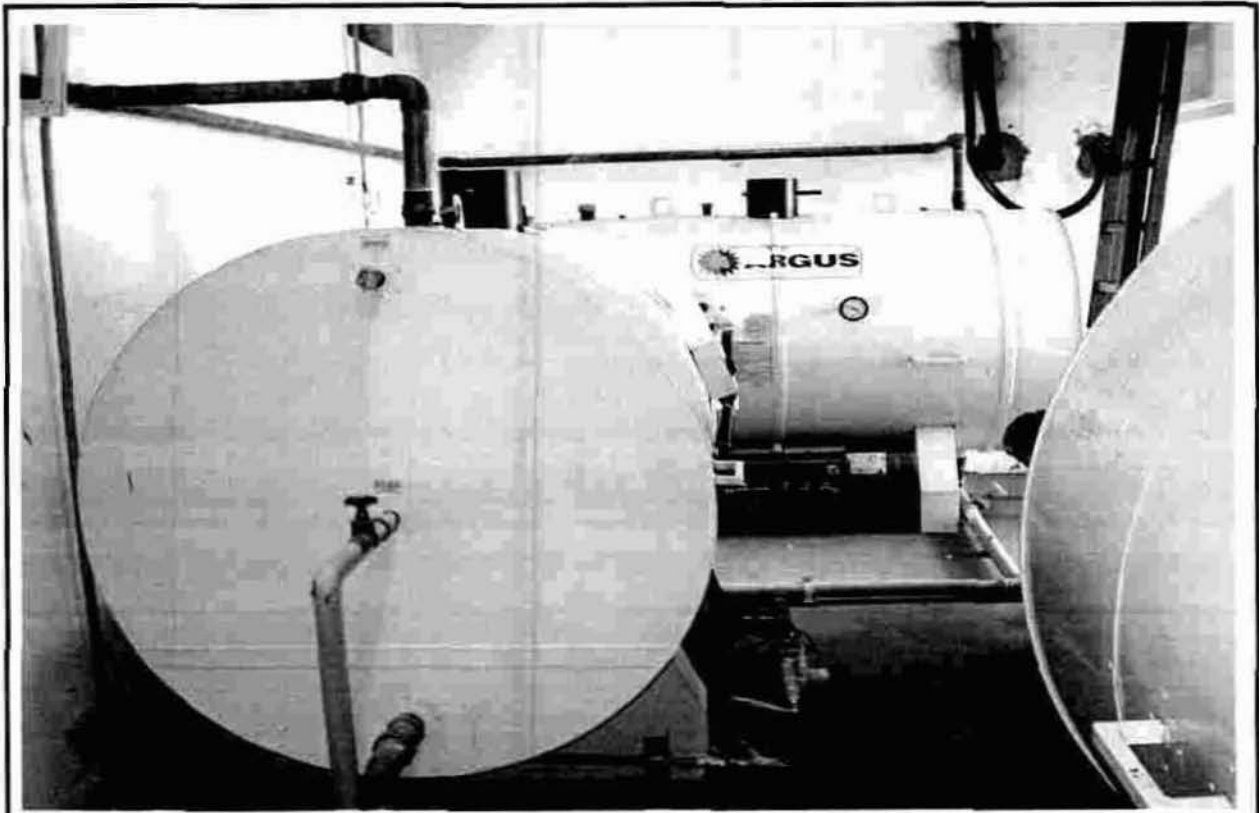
Sistema de Aquecimento/Hospital Regional de Ponta Grossa – Vista Interna – 19/04/2010
